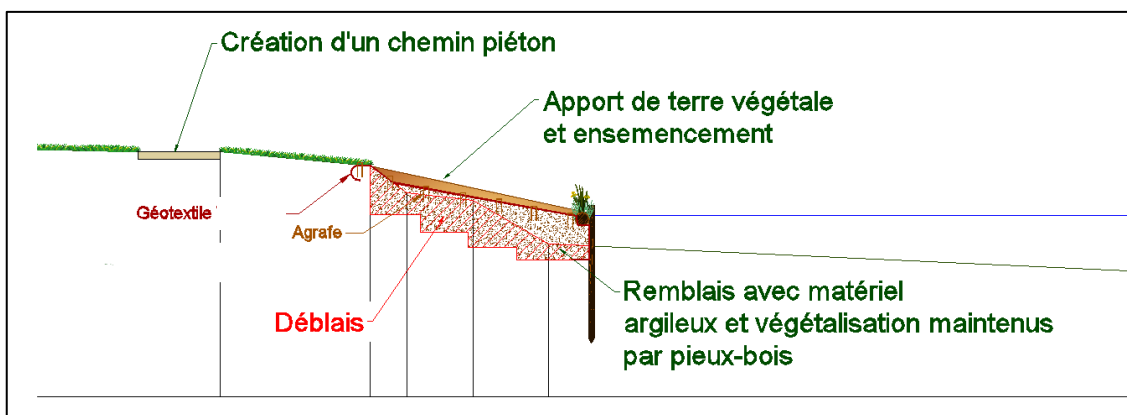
Coupe en travers du confortement entre le plan d'eau et la rivière
